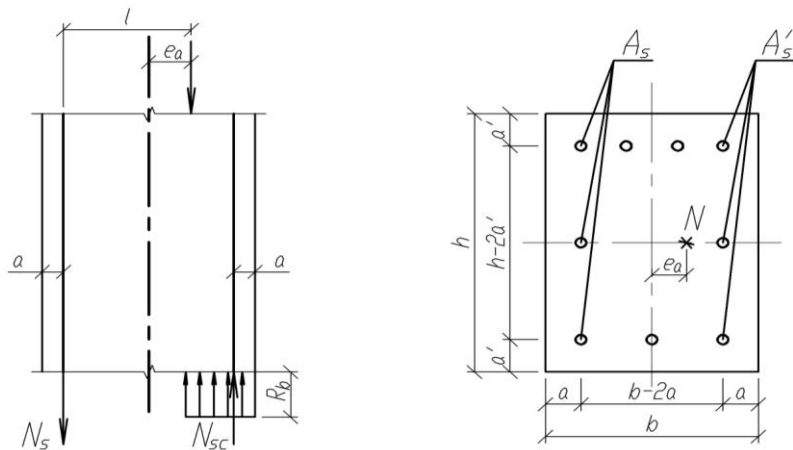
К расчету прочности надкрановой части колонны при несимметричном армировании из плоскости поперечной рамы
